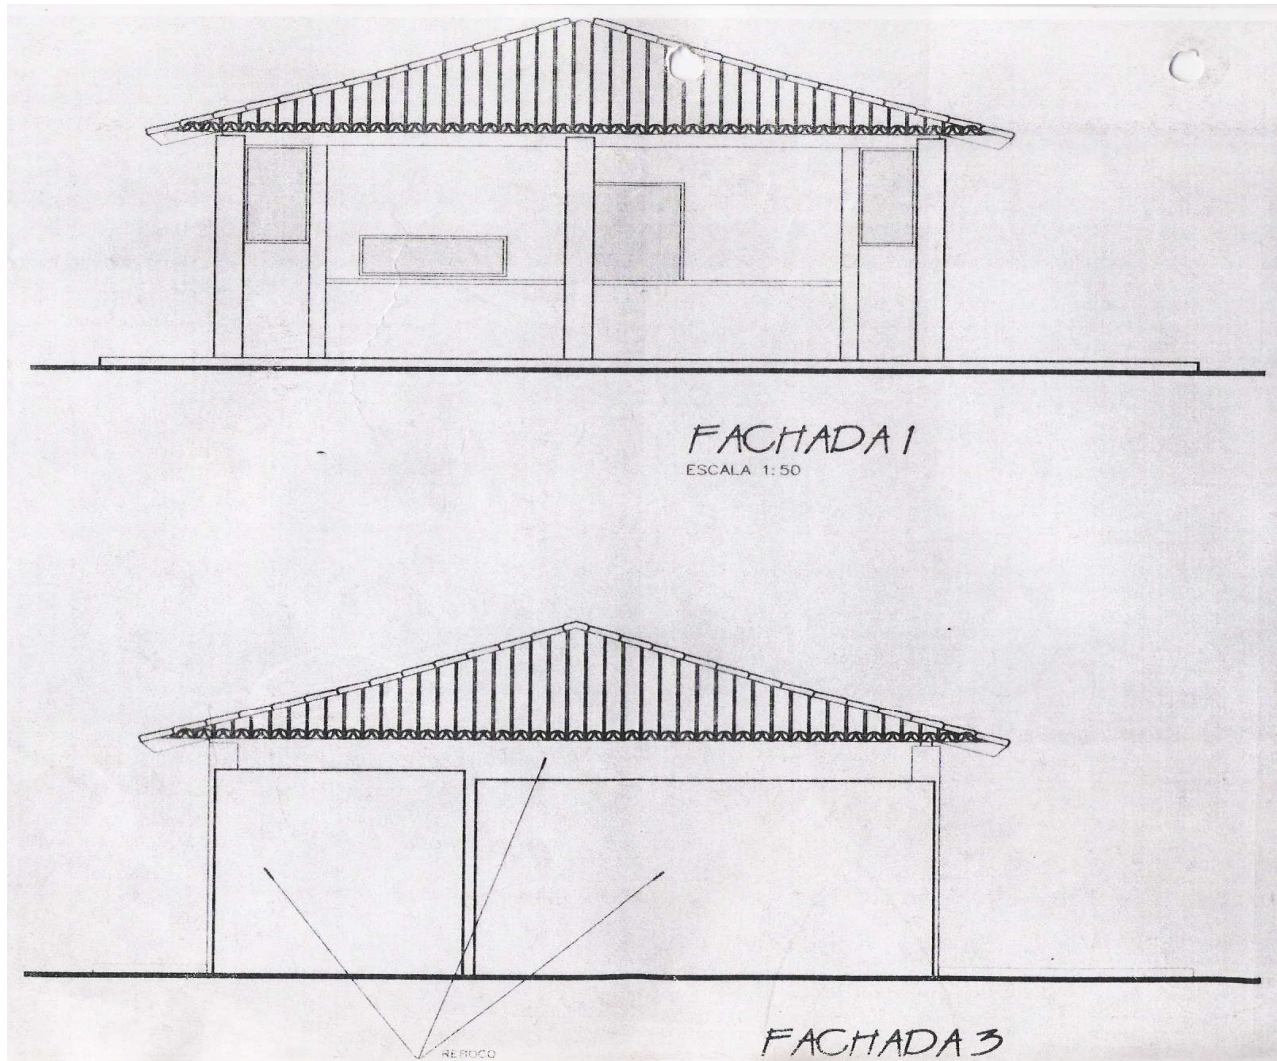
Croqui da fachada da lanchonete da Piscina Pedreira.
